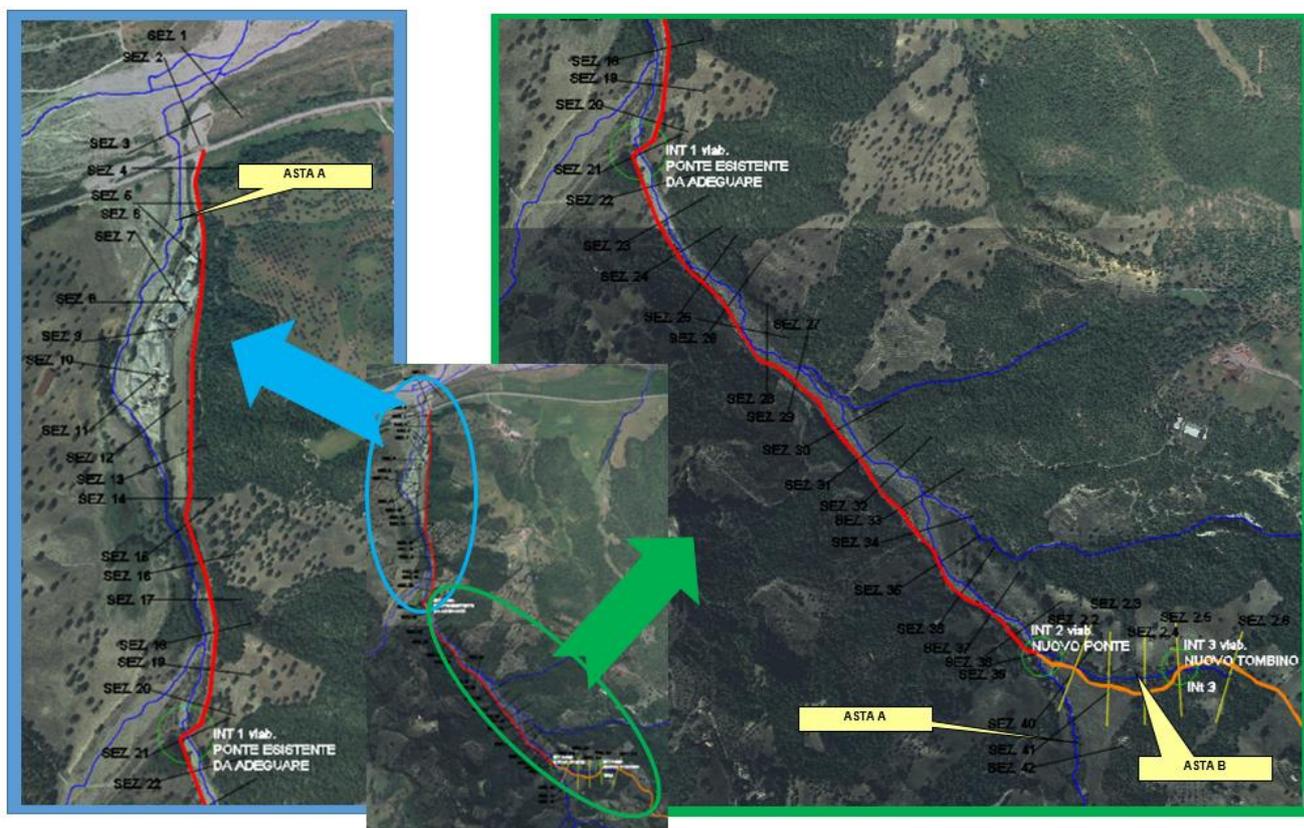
Planimetria con indicazione del reticolo e delle sezioni su ortofoto asta A e B
